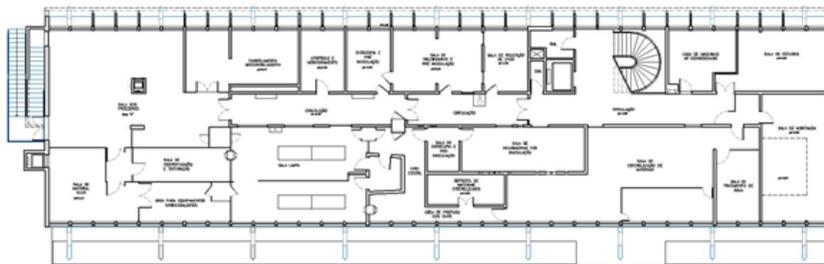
Planta baixa 2º pavimento do Pavilhão Henrique Aragão, 2019.
